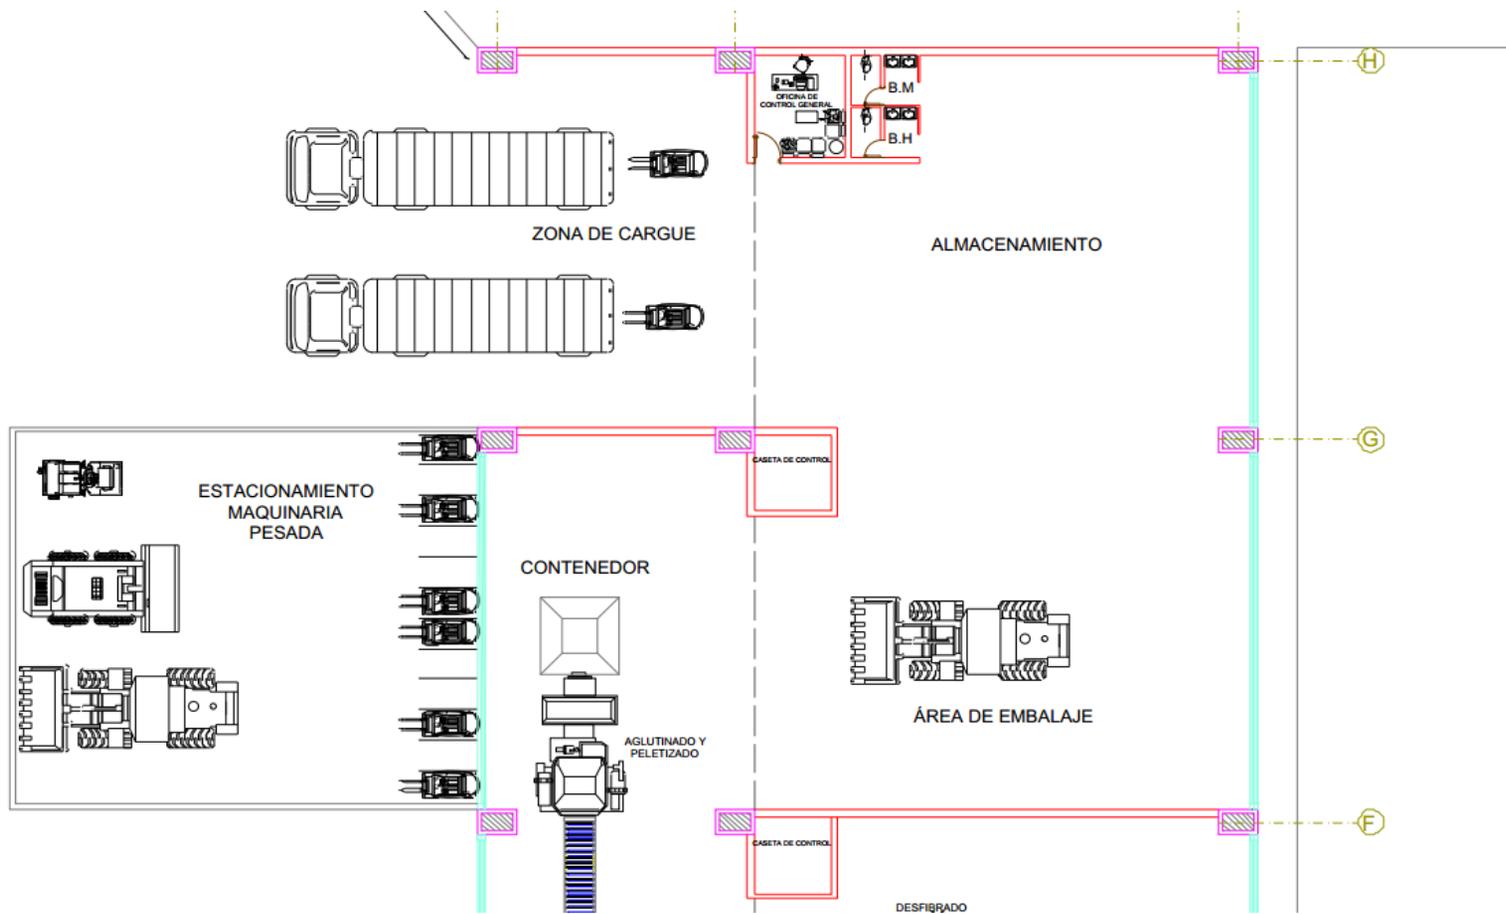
Vista de zona de procesamiento de plástico a detalle n° 2: continuación de la ilustración anterior
